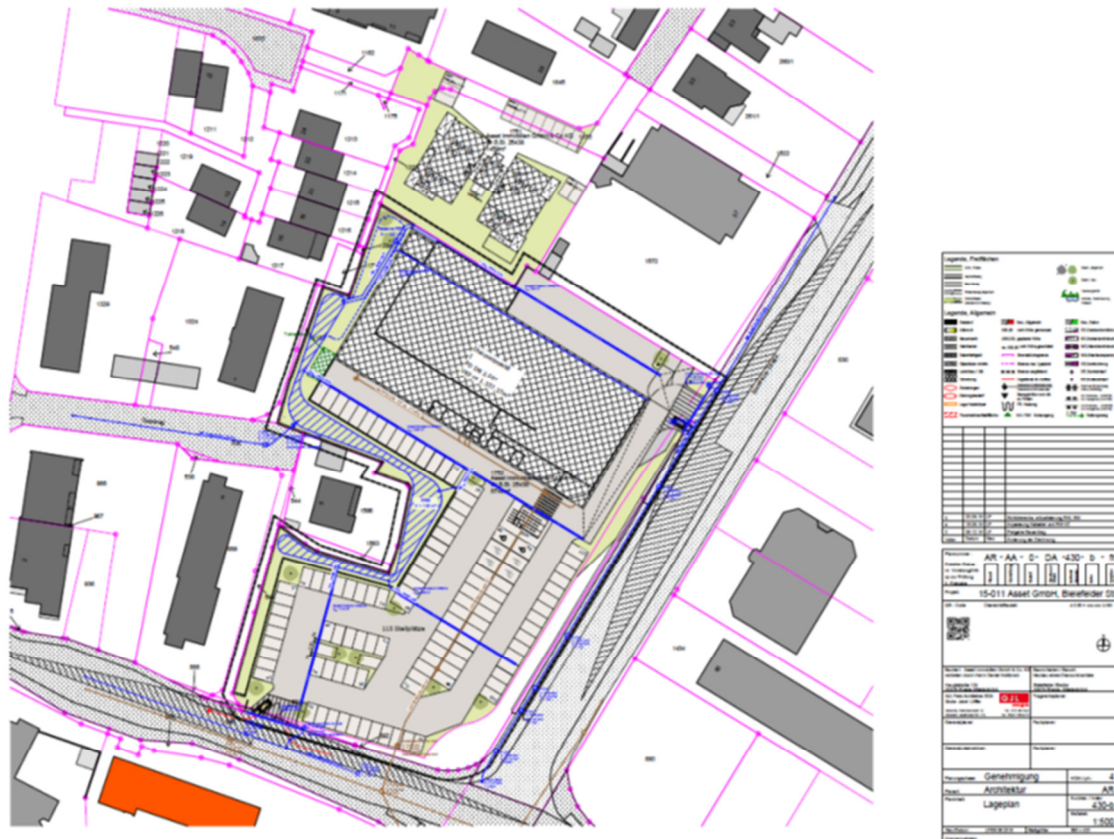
Lageplan der geplanten Wohnbebauung nördlich des geplanten Discoutmarktes (GfL 2018).
